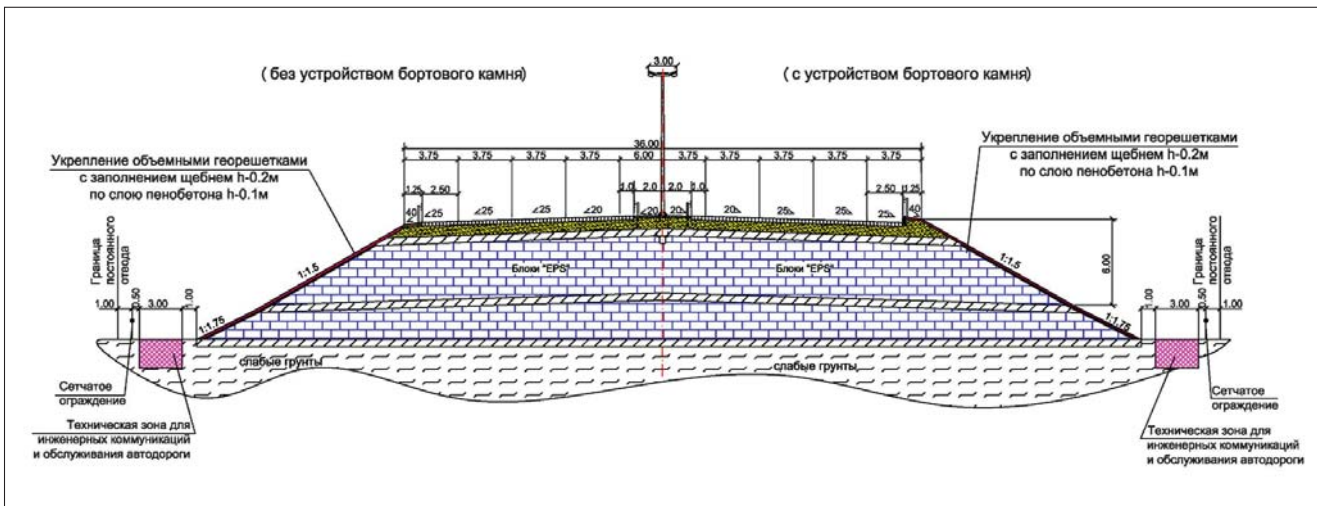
Схема комбинированной дорожной насыпи на слабых грунтах с применением EPS-блоков и пенобетона
